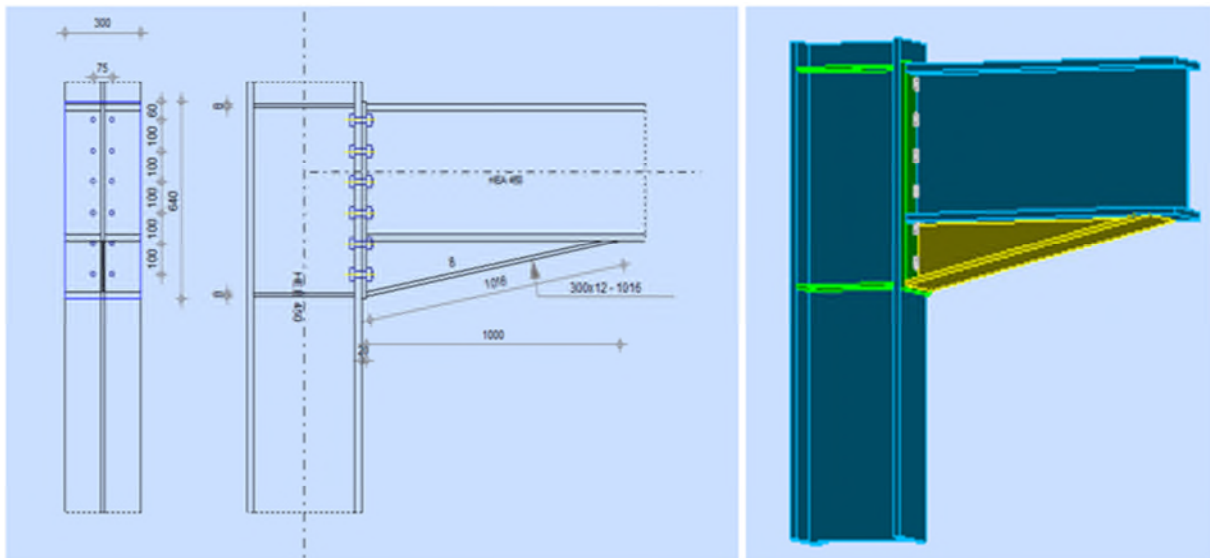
Assemblage poteau - poutre maitresse par une platine.
